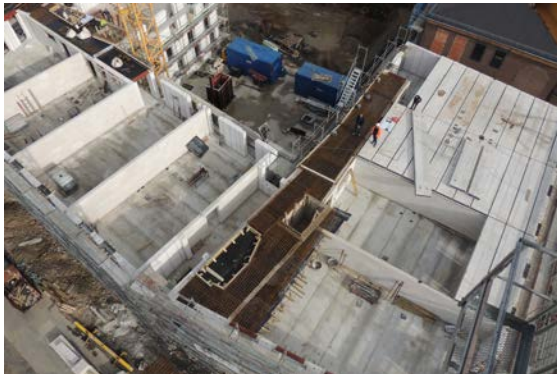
Vorgefertigte Hohlkammer-Decken und geschosshohe KS-Fertigteile im Montagezustand auf der Baustelle.
